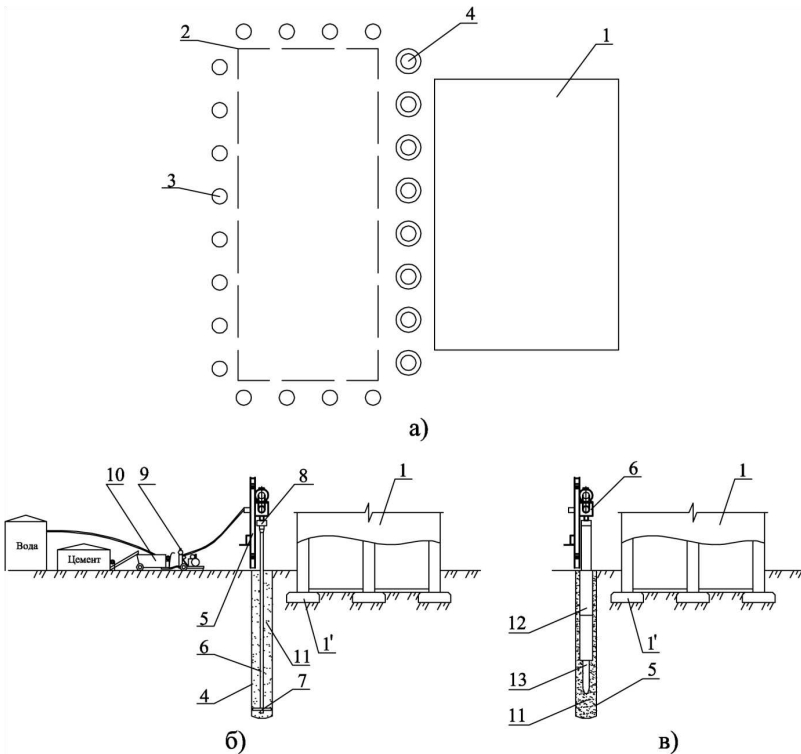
Технологічна схема укріплення укосів котловану і влаштування тимчасової підпірної стінки фундаментів будівлі:
